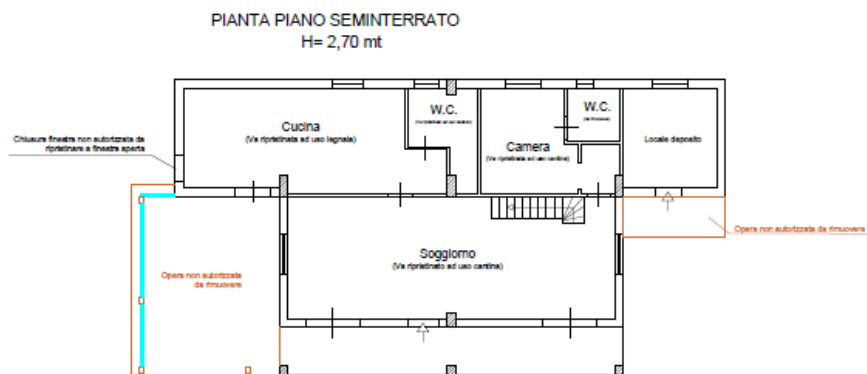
PLANIMETRIA SEMINTERRATO (in allegato)
